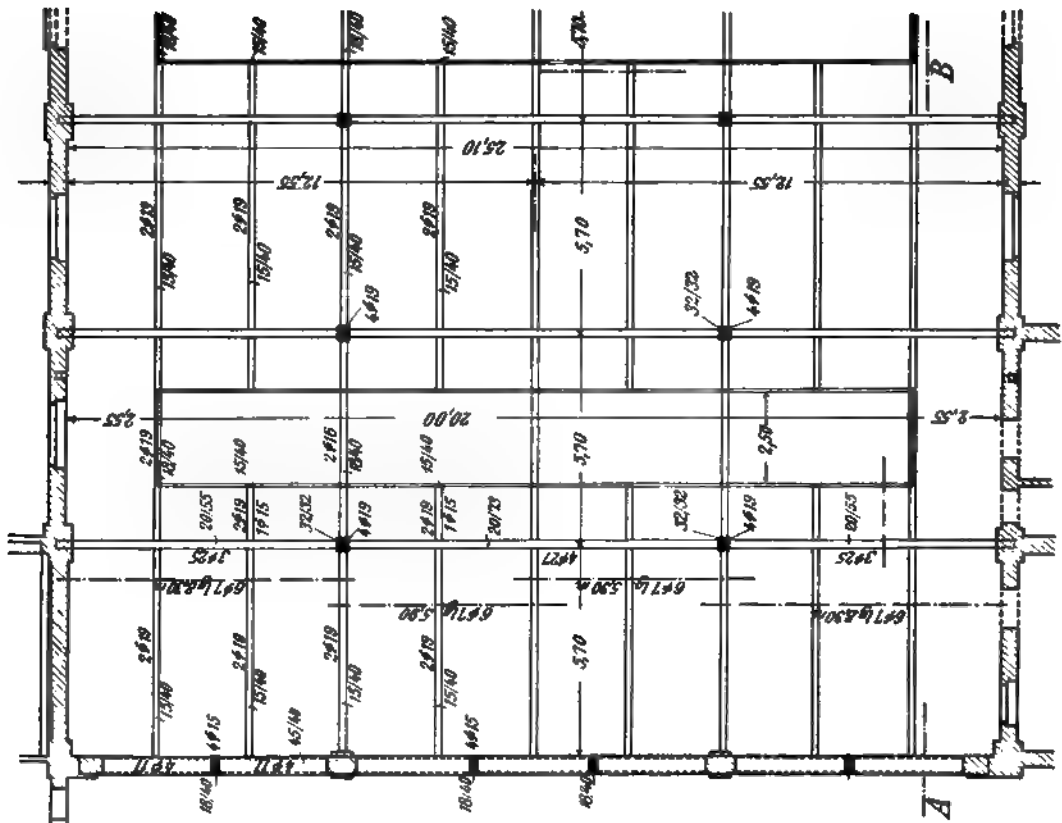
Grundriß der Wagenhalle in Wien-Breitensee.
